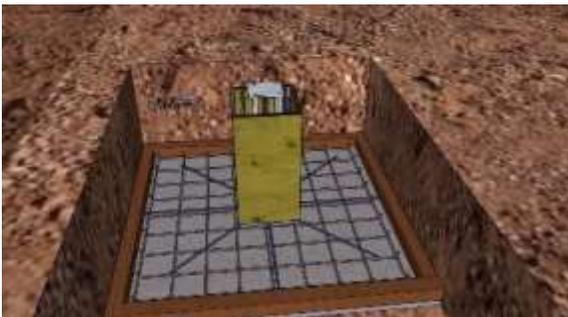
Zapata aislada, (29/08/2019) recuperada de:
